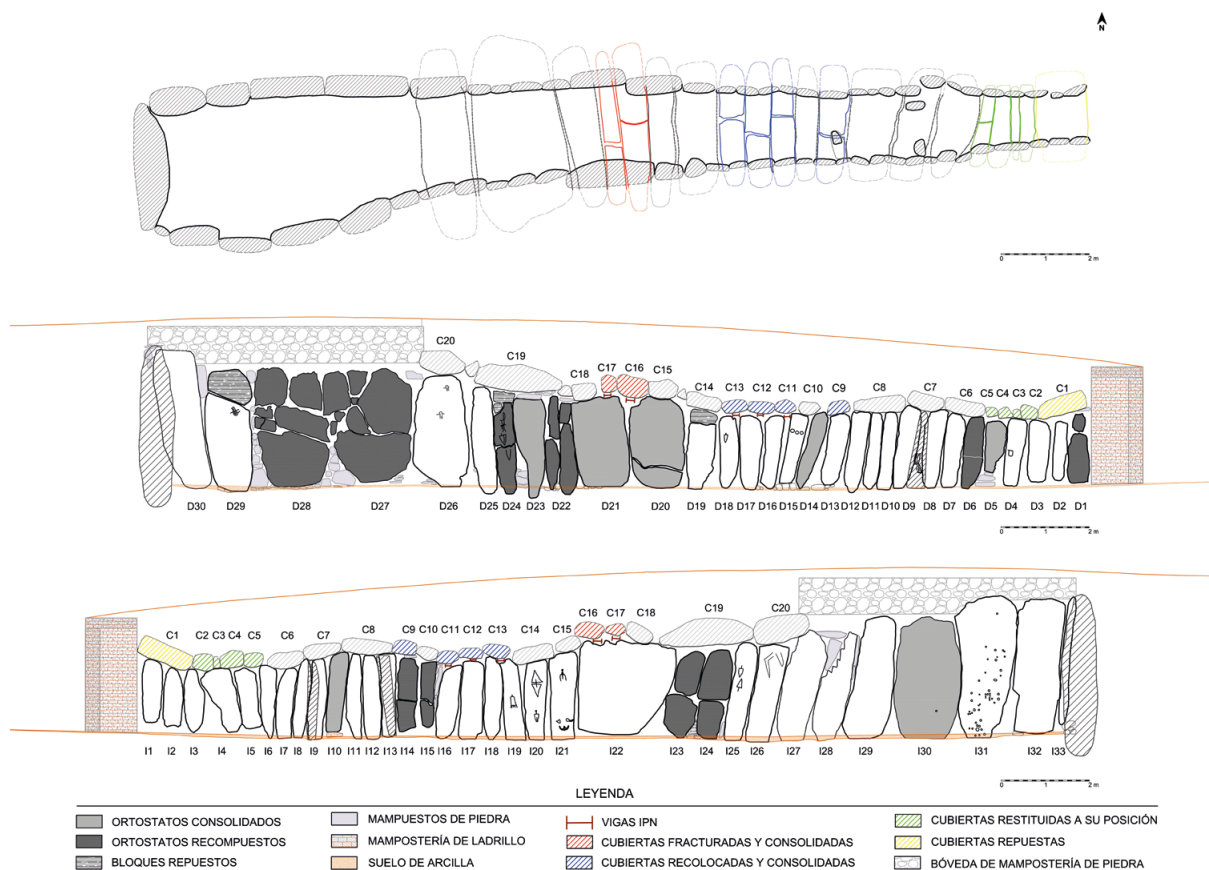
Planta y alzados del dolmen de Soto con los grabados identificados por Obermaier y los elementos de la obra de restauración de 1923. Planimetría de las intervenciones arqueológicas de 2012-2013.
